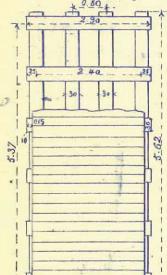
Fondations de ponts sur plateformes. (Pont de Tours sur la Loire).
